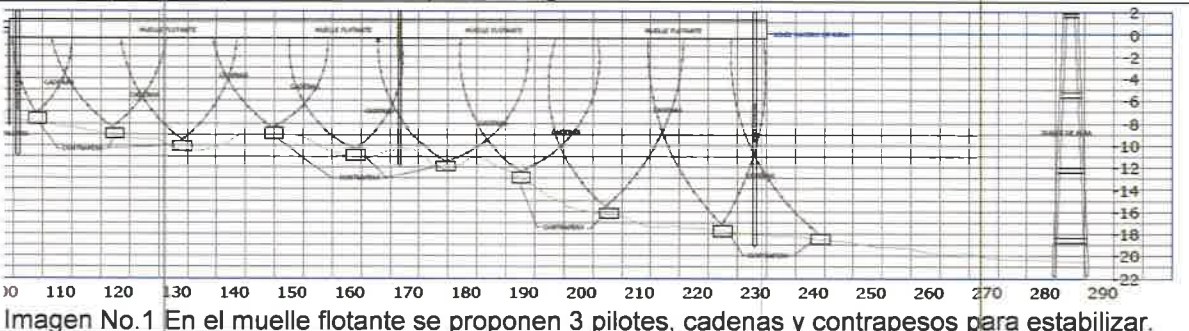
En el muelle flotante se proponen 3 pilotes, cadenas y contrapesos para estabilizar.
